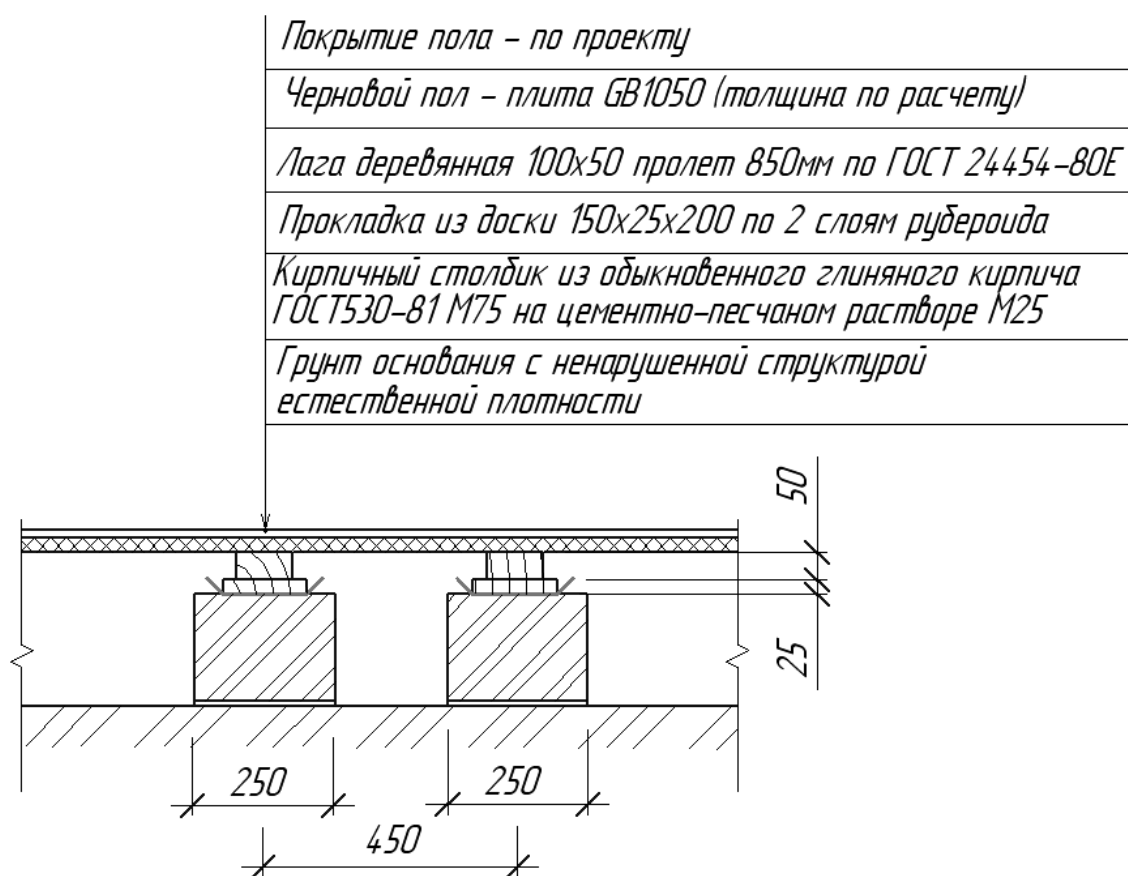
Конструкция пола по грунту с применением плит системы плит GREEN BOARD® без утепления с покрытием на деревянных лагах
